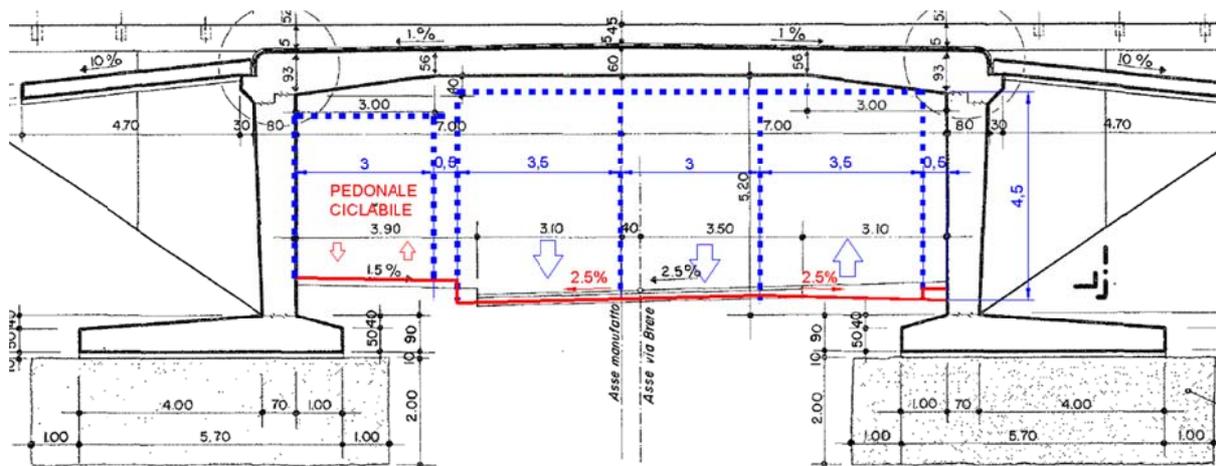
Sezione trasversale sottopasso di via Brere – Variante 4a
